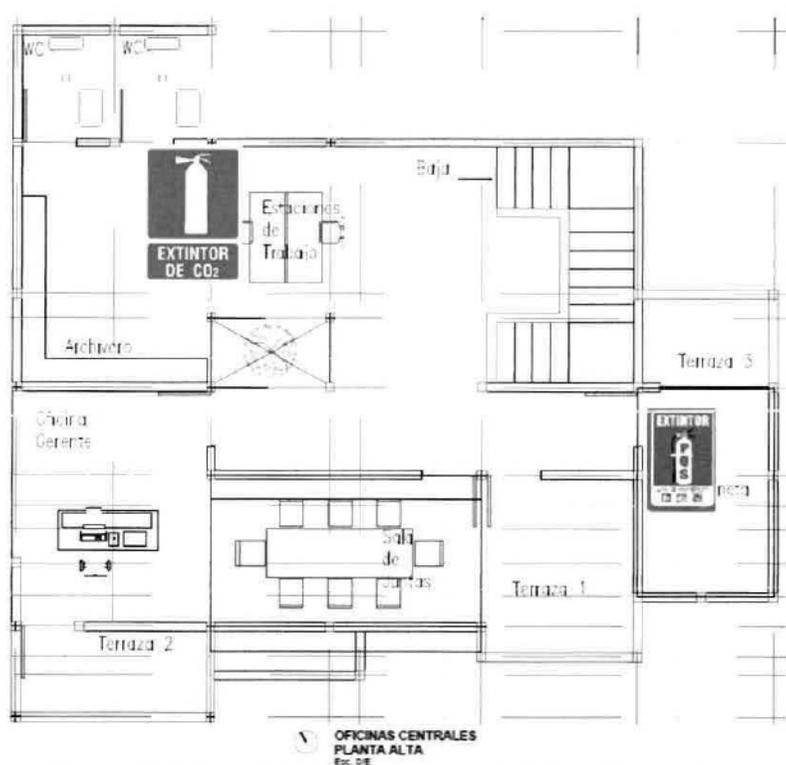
Ubicación de extintores – Oficinas Planta Alta
